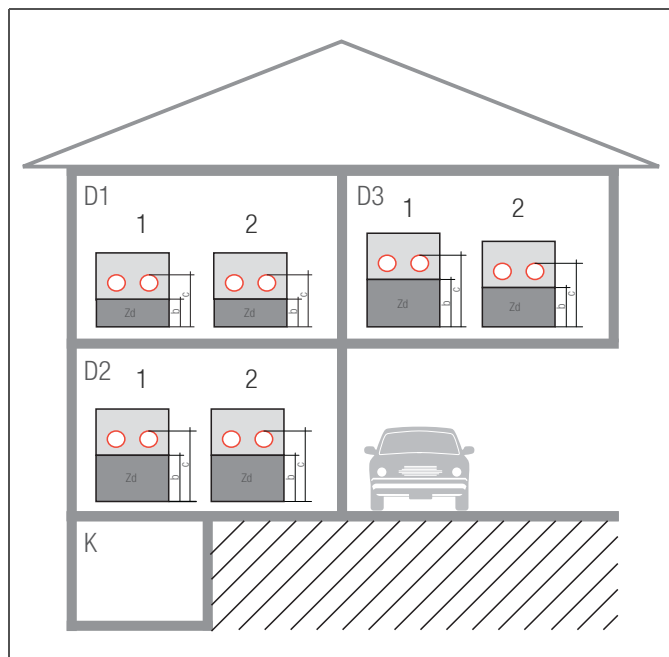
Минимальные требования к теплоизоляции системы крепления труб на арматурной сетке
